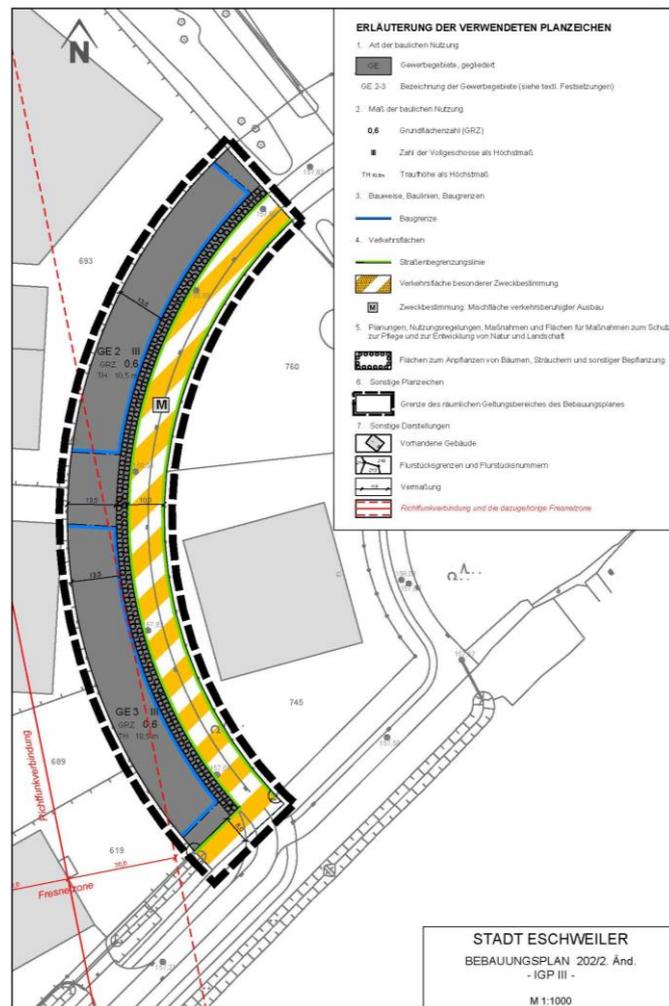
Entwurf der 2. Änderung des BP 202 - Industrie- und Gewerbepark III –
